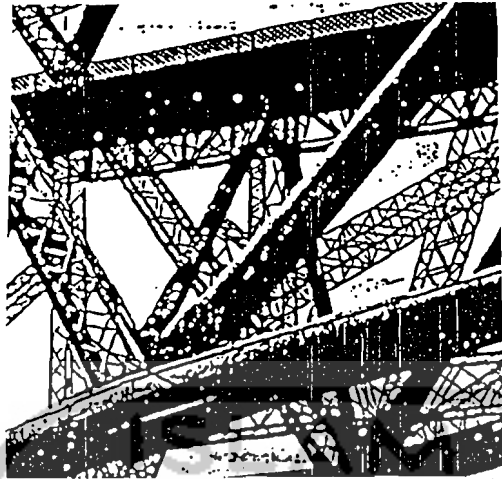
Sistem stabilitas struktur sekaligus memberi nilai estetika pada bangunan.
